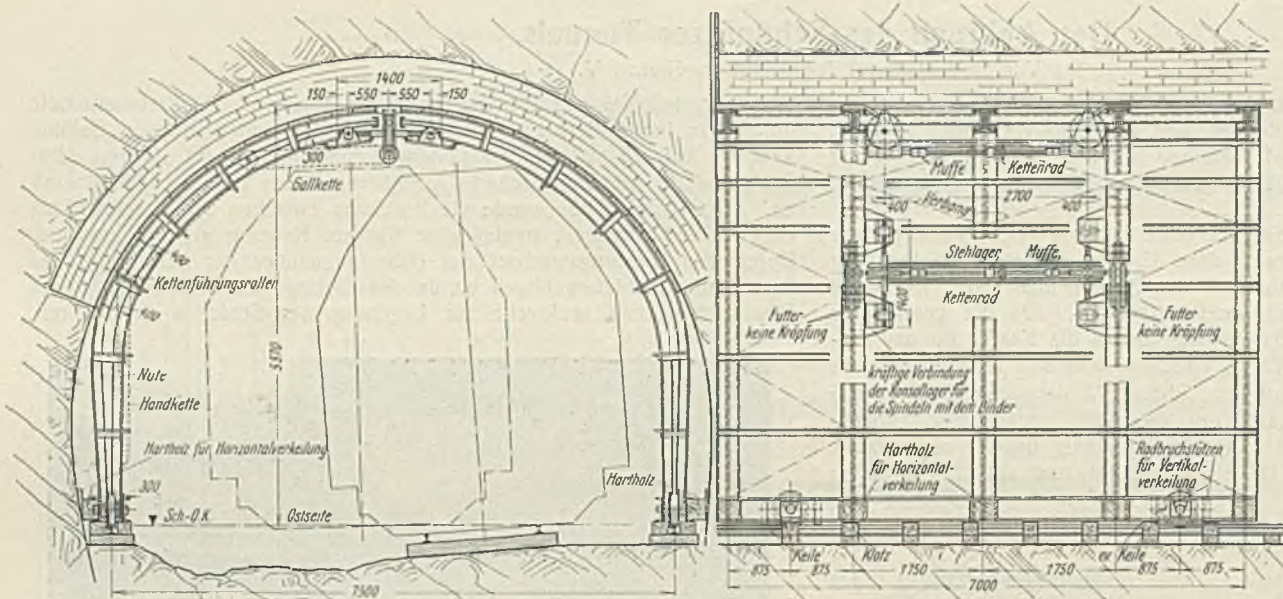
Lehrgerüst (Querschnitt und Längsschnitt).
